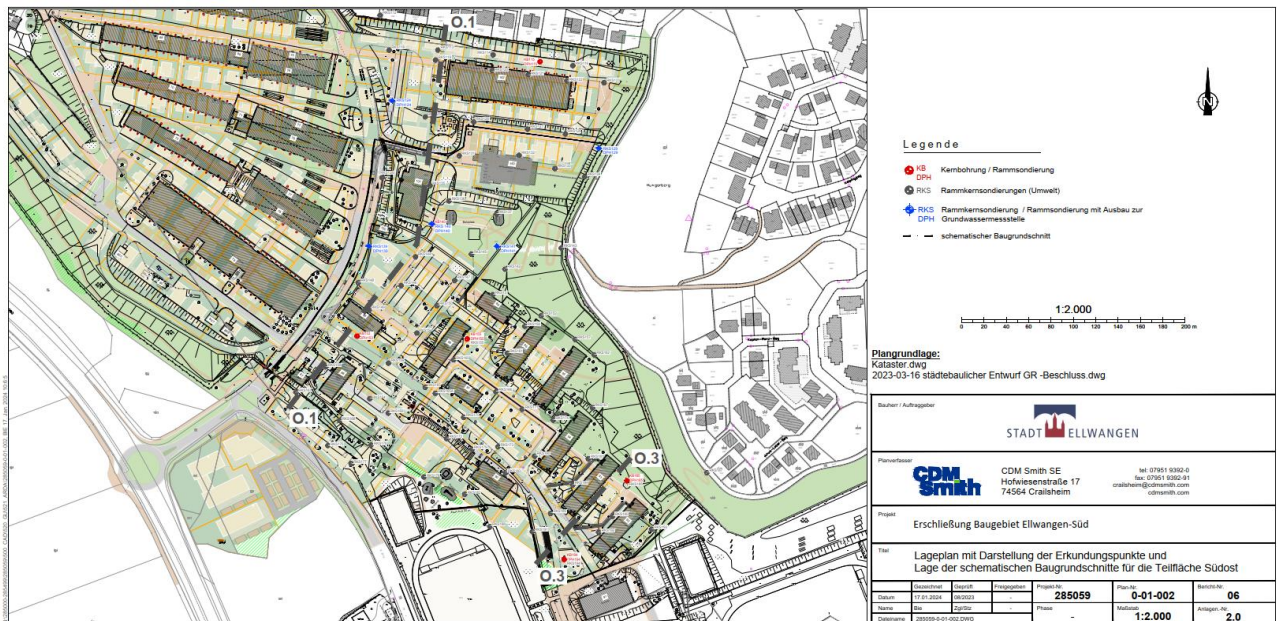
Lageplan mit Erkundungspunkten und Schnittebenen Teilfläche Ost
